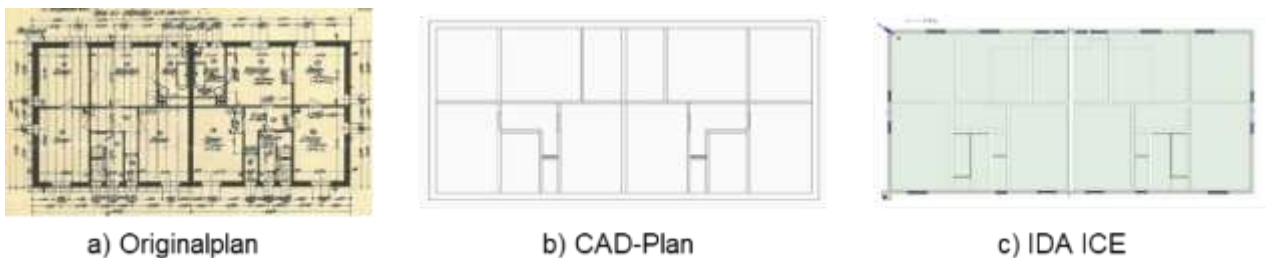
Grundriss des Erdgeschosses Sonnenblick 6 und 8
